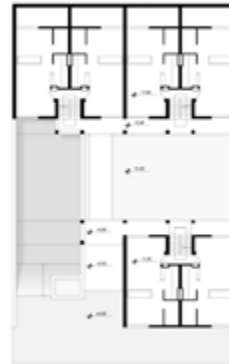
Planta nivel 0.00. Fuente La Plata Arquitectura Moderna. Fig.5 Vista Calle 22. Fuente: C. Carasatorre.
